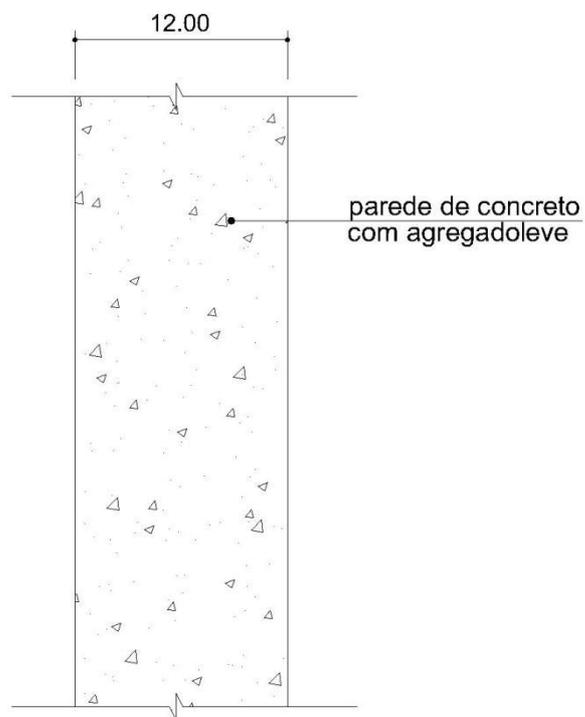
Detalhamento Construtivo da Parede de Concreto Leve: Corte Vertical
